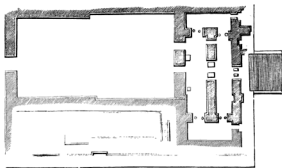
Grundriss des Palastes des Essarhaddon zu Nimrud.
